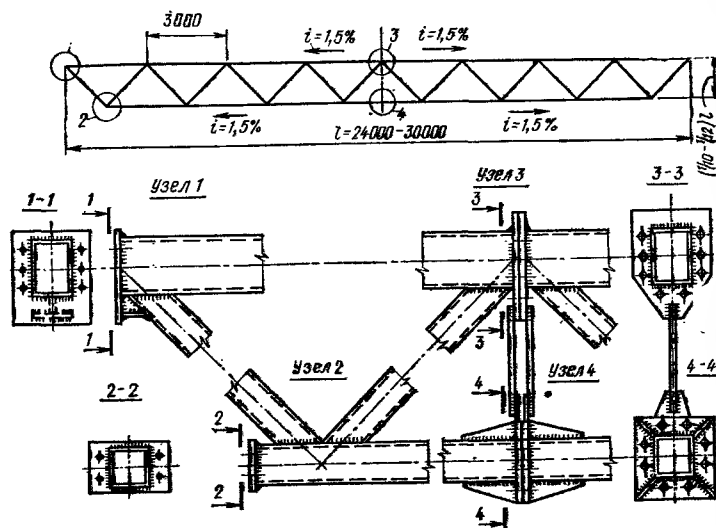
Узлы стропильной фермы из труб прямоугольного сечения
